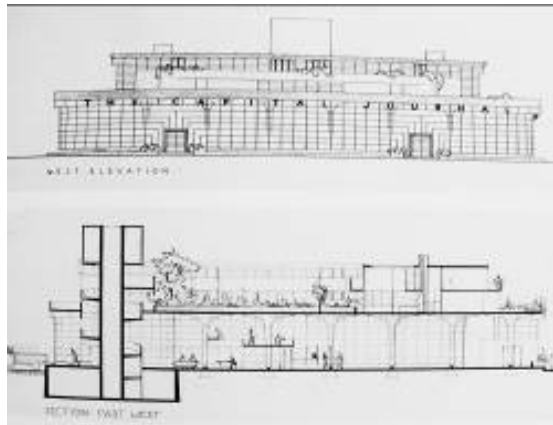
Alzado este y sección del proyecto para le Capital Journal
